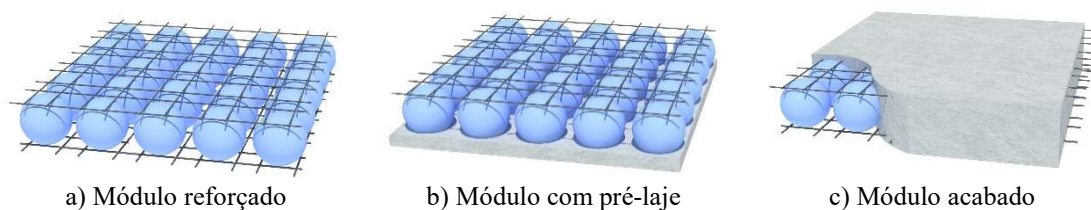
Tipos construtivos de lajes *BubbleDeck
